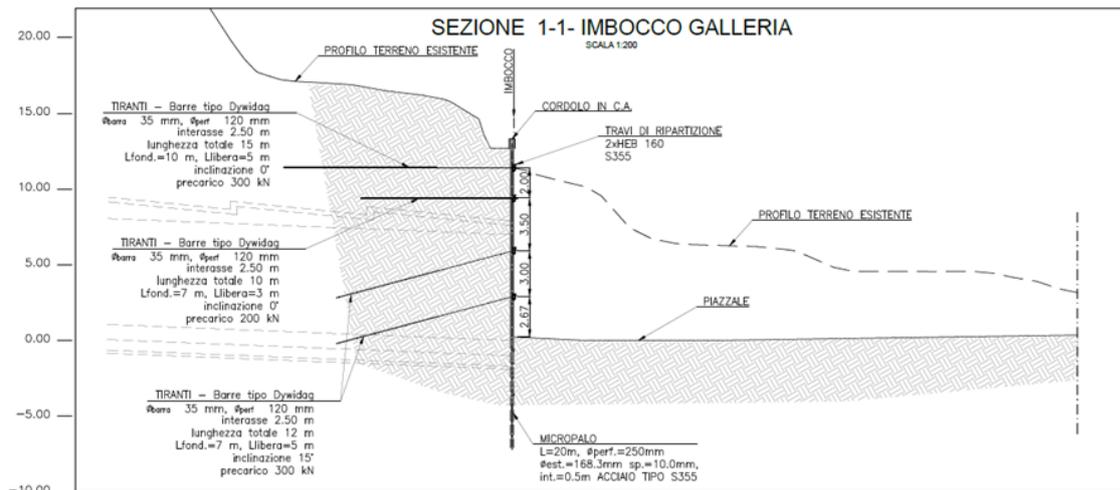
Sezione trasversale della paratia in corrispondenza dell'imbocco della galleria di accesso alla centrale
